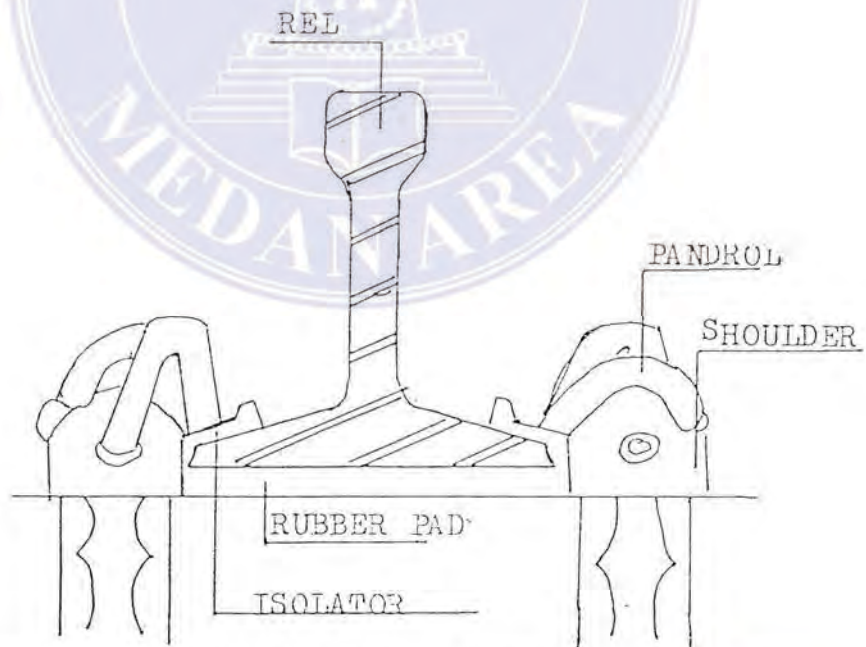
Tampak atas penampang rel dengan bantalan beton
